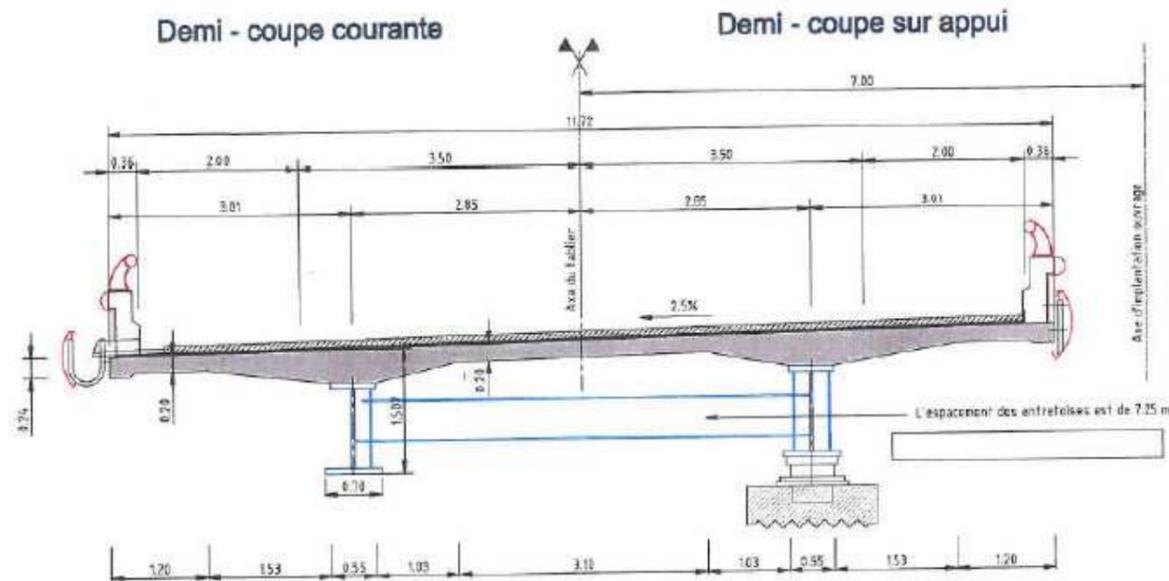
Coupe transversale du tablier actuel (source EPOA 1999 – SETRA)
